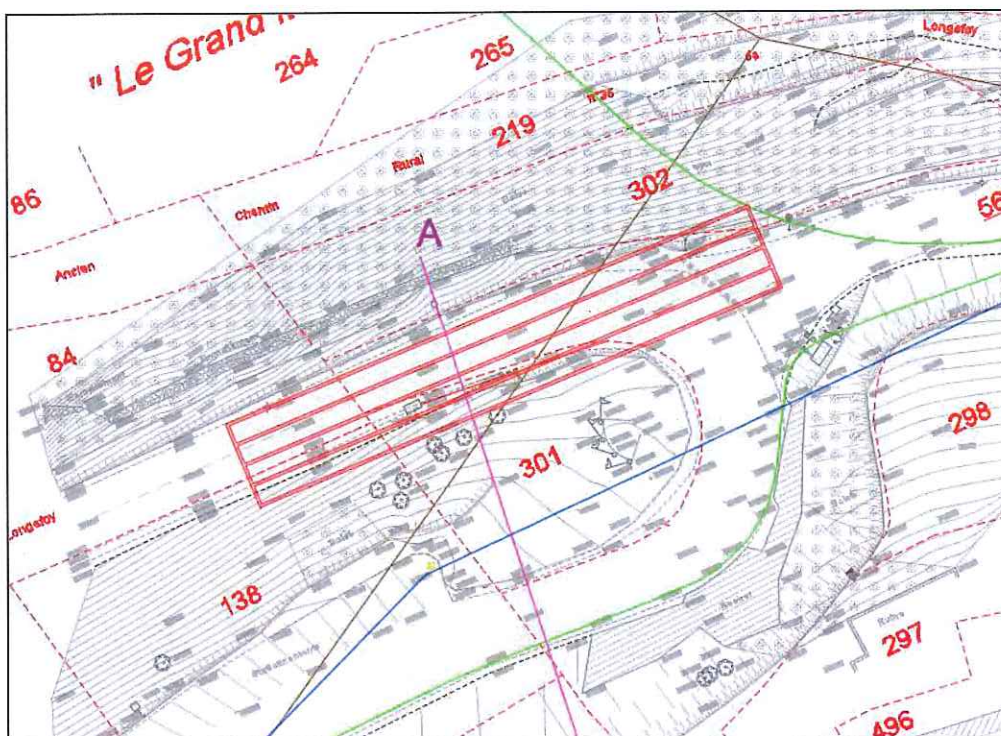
Vue en plan - bassin de stockage – dalots enterré
